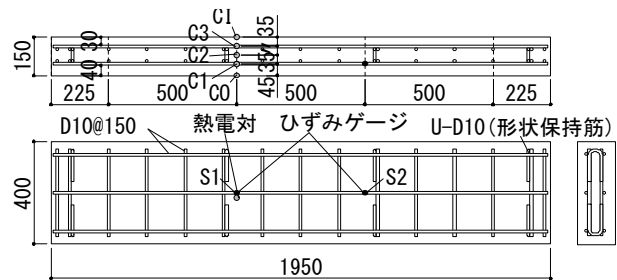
試験体形状・配筋図 T1～3, N1～3 (単位 mm)
